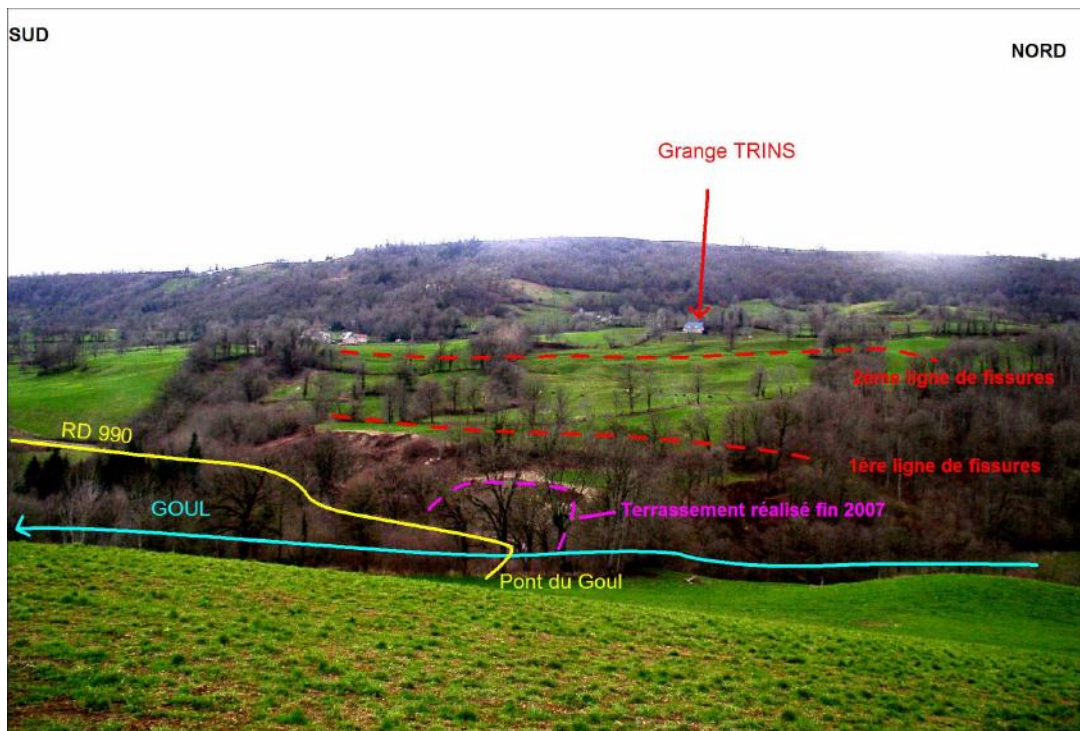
Situation générale du glissement du Pont du Goul en avril 2008 (photo BRGM)
